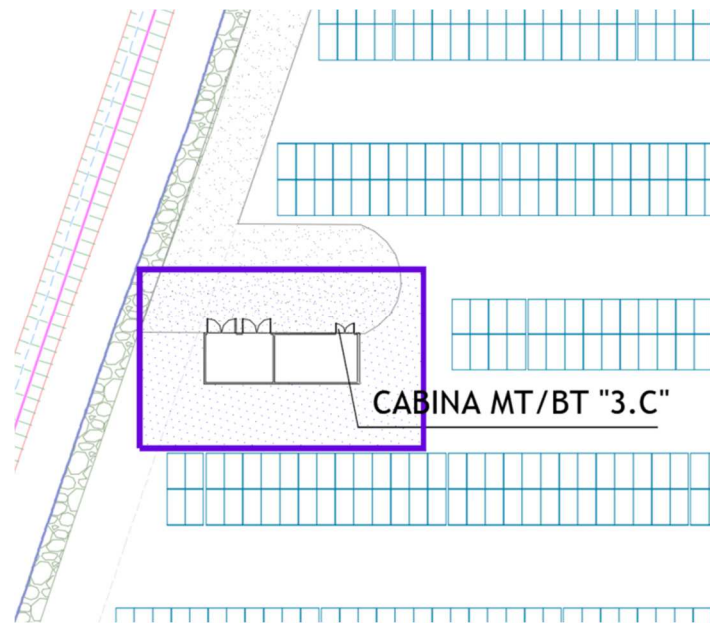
Individuazione fasce di rispetto Cabina MT/BT 3.C
